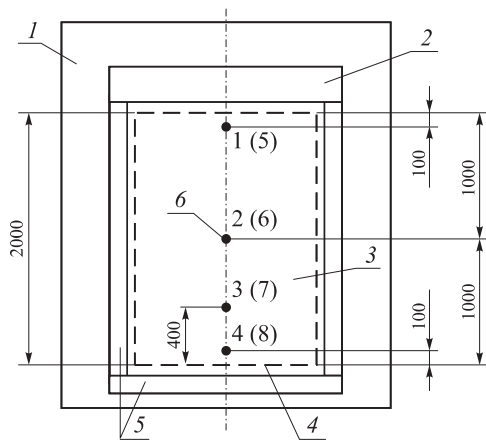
Схема установки термопар: 1 — железобетонный вкладыш; 2 — корпус шторы; 3 — рабочее полотно; 4 — проем; 5 — направляющий элемент; 6 — контрольные точки
